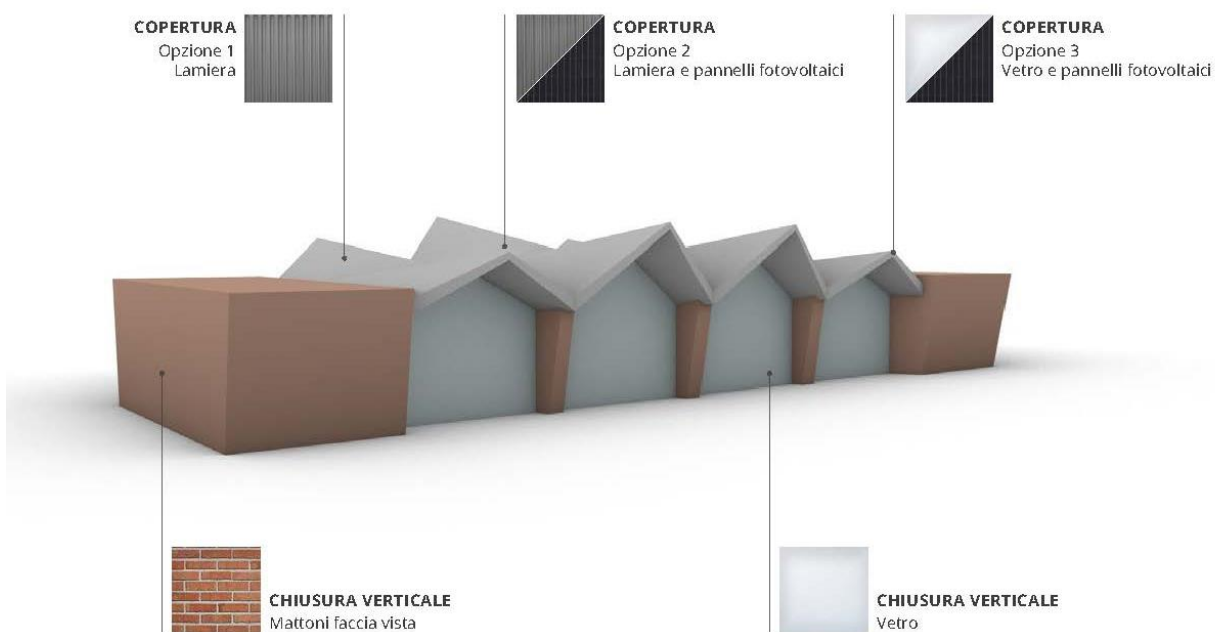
Proposta ‘Origami’: Vista Prospettiva
